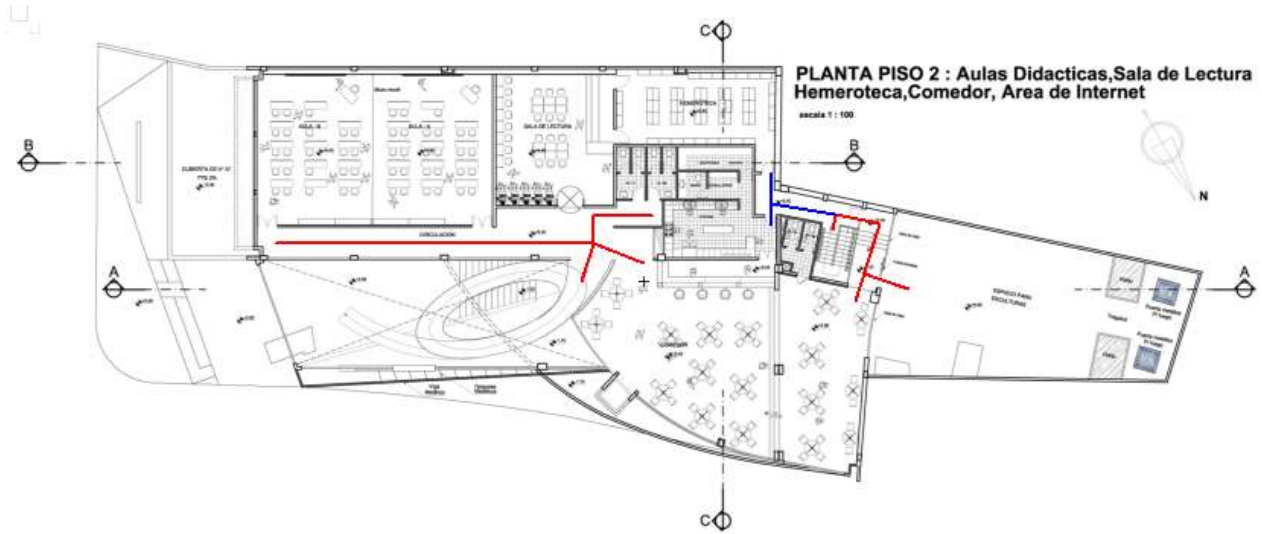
PLANTA PISO 2 CINEMATECA BOLIVIANA
